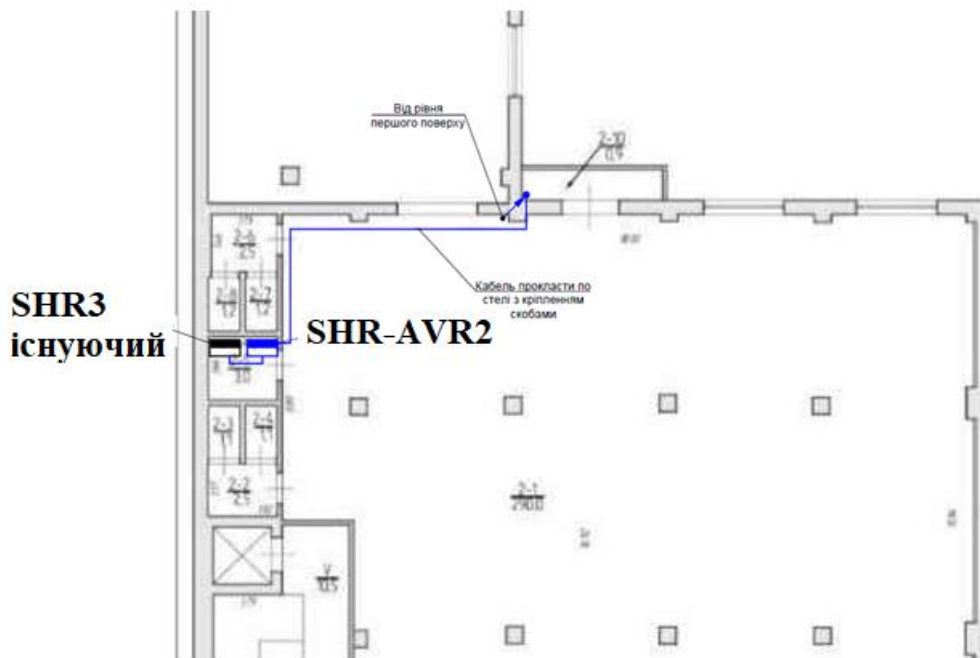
Схема монтажу кабеля електроживлення на другому поверсі
